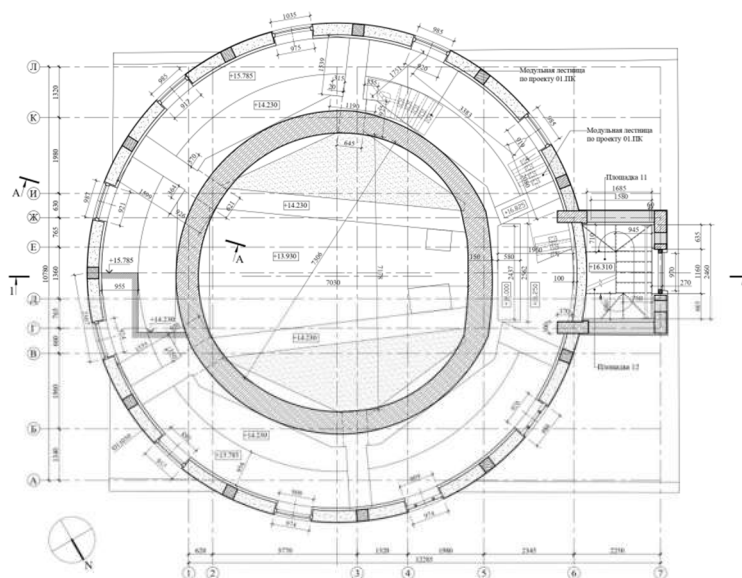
План на отм. +15.785. Сечение I-I. Источник: <https://tower1929.ru/restoration>
